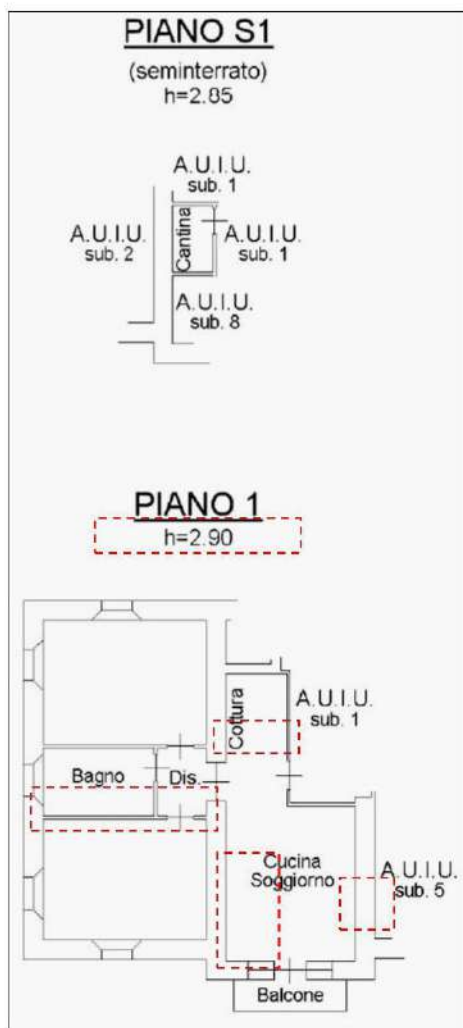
Planimetria castale Appartamento 4 con cantina (Sub. 6)
